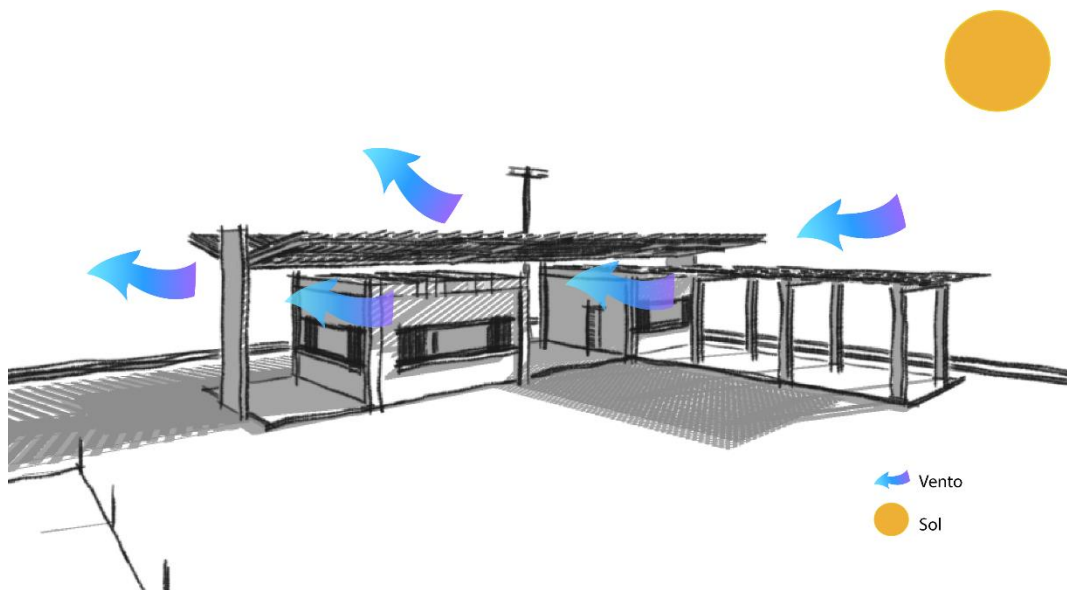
Esquema de insolação e ventilação da Edificação de Apoio.
